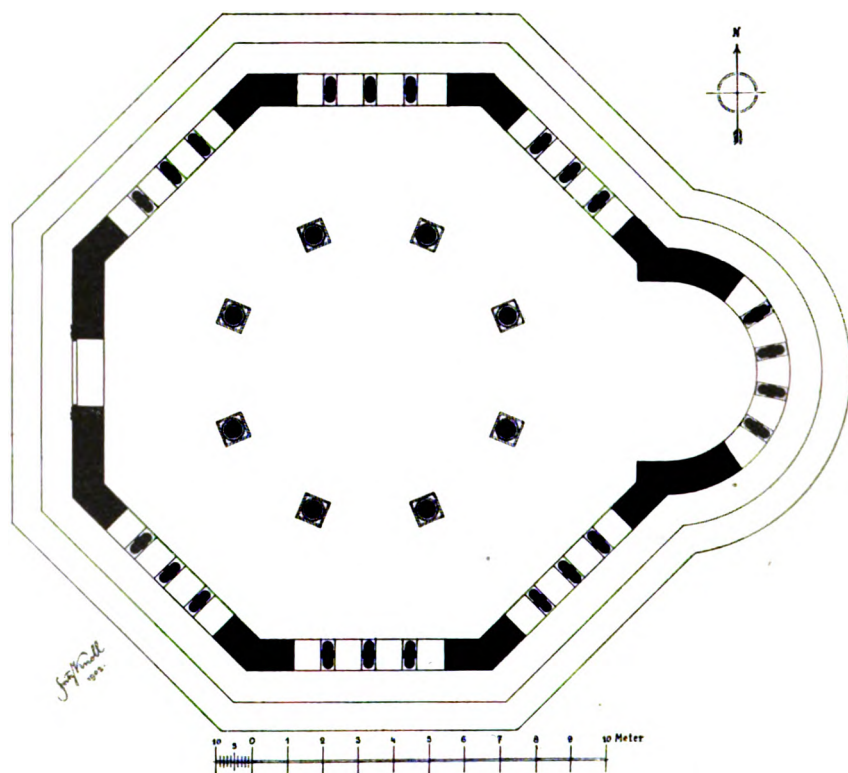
Grundriss des Centralbaus in Isaura.
